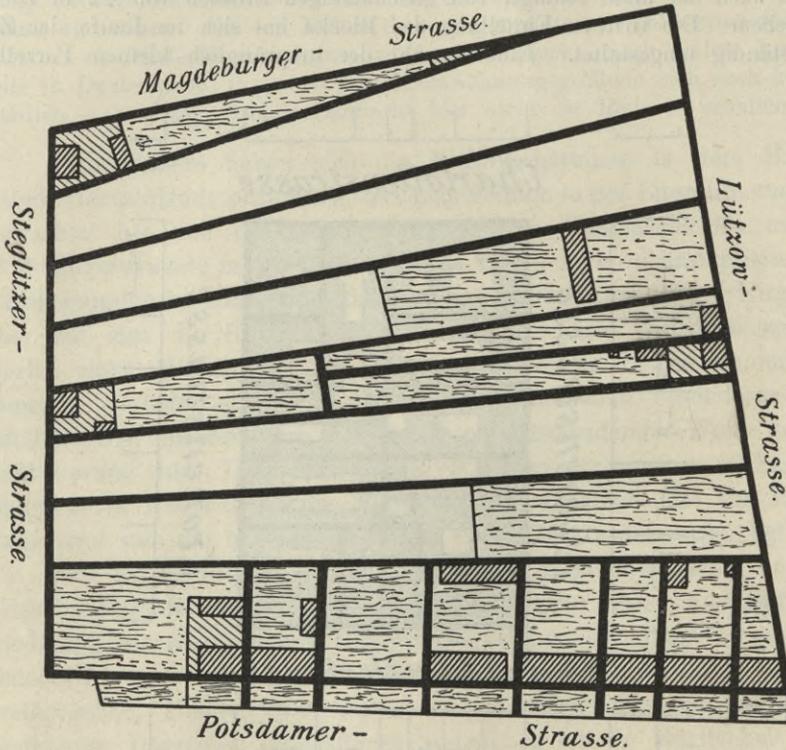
Berliner Baublock im Jahre 1850/51. Maßstab 1:2000.
